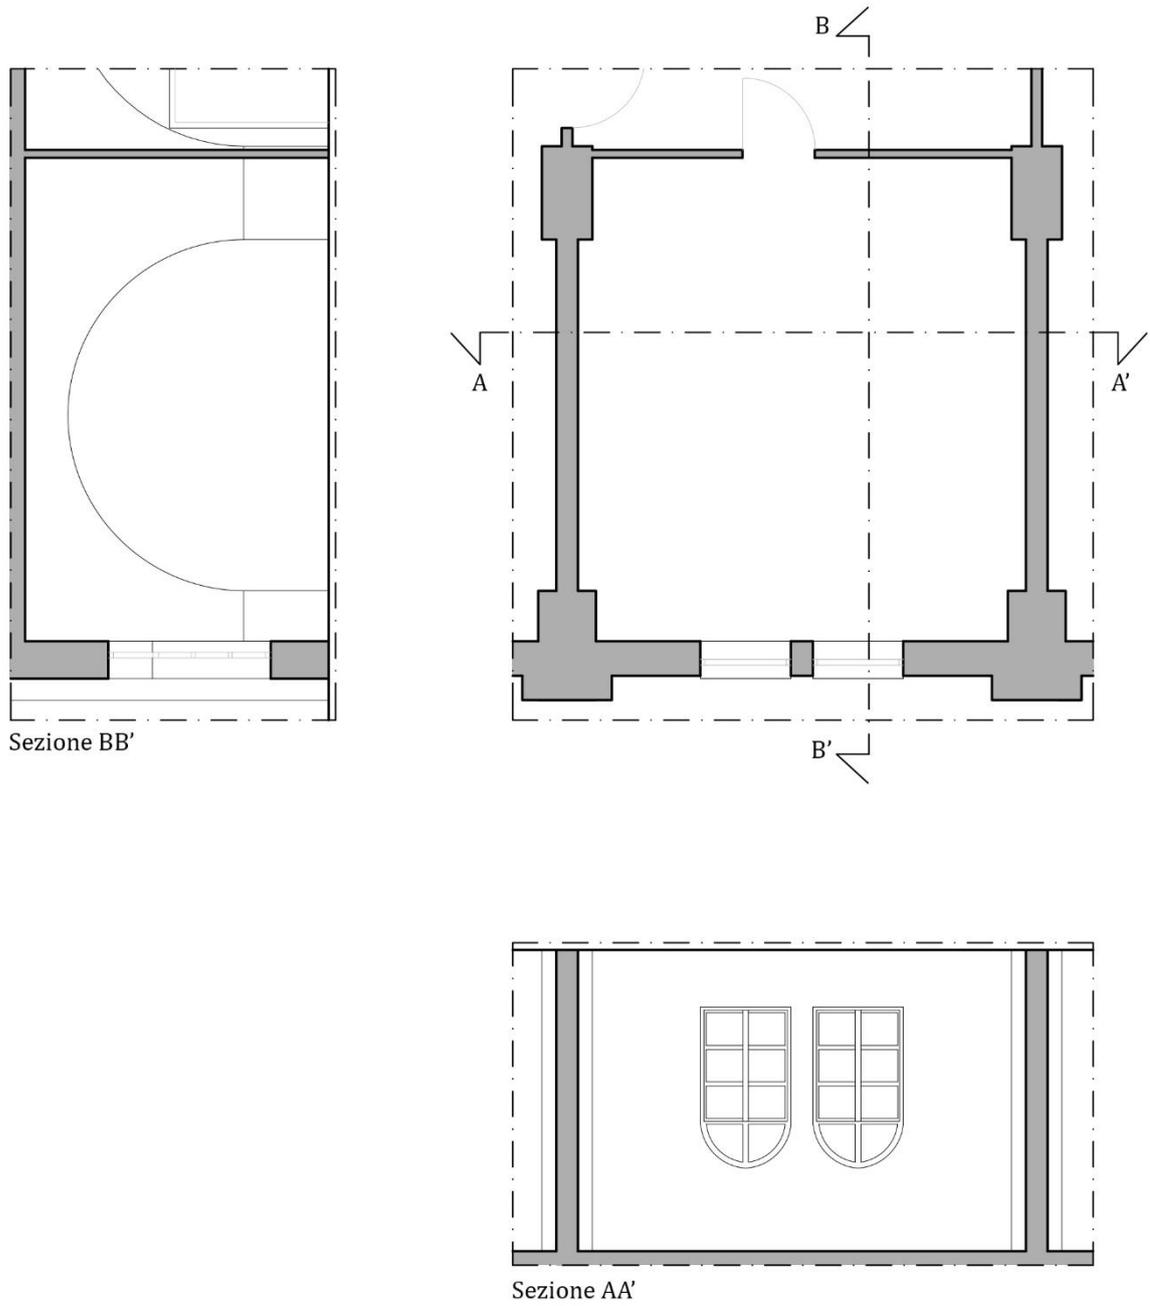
Pianta e sezioni in scala 1:100 dell'aula con esposizione a sud-ovest situata al primo piano.
